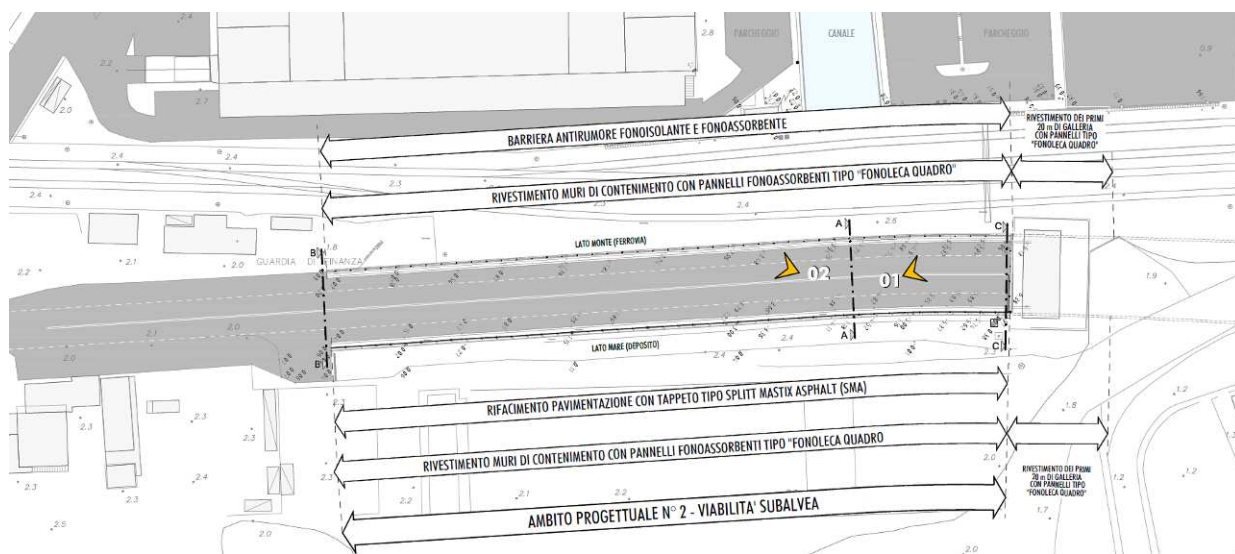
Stralcio planimetrico dell'ambito d'intervento.
